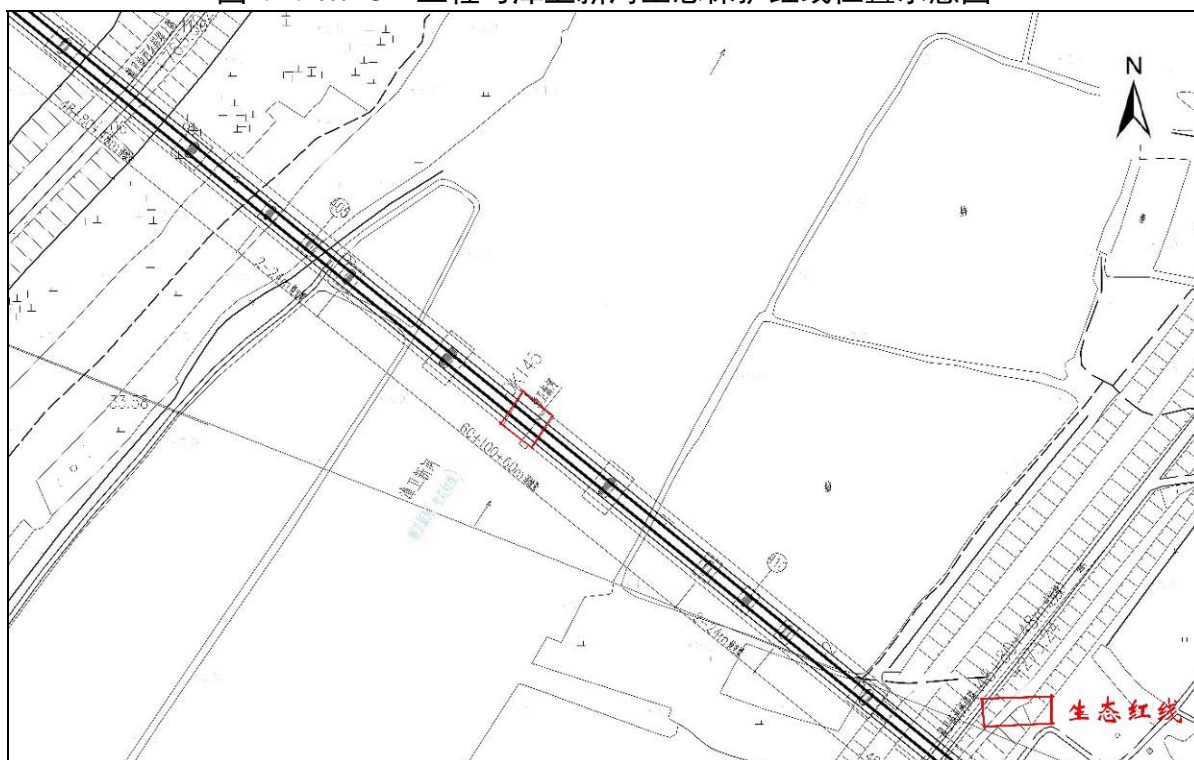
XI-9 工程跨越漳卫新河桥梁及墩台平面布置示意图
